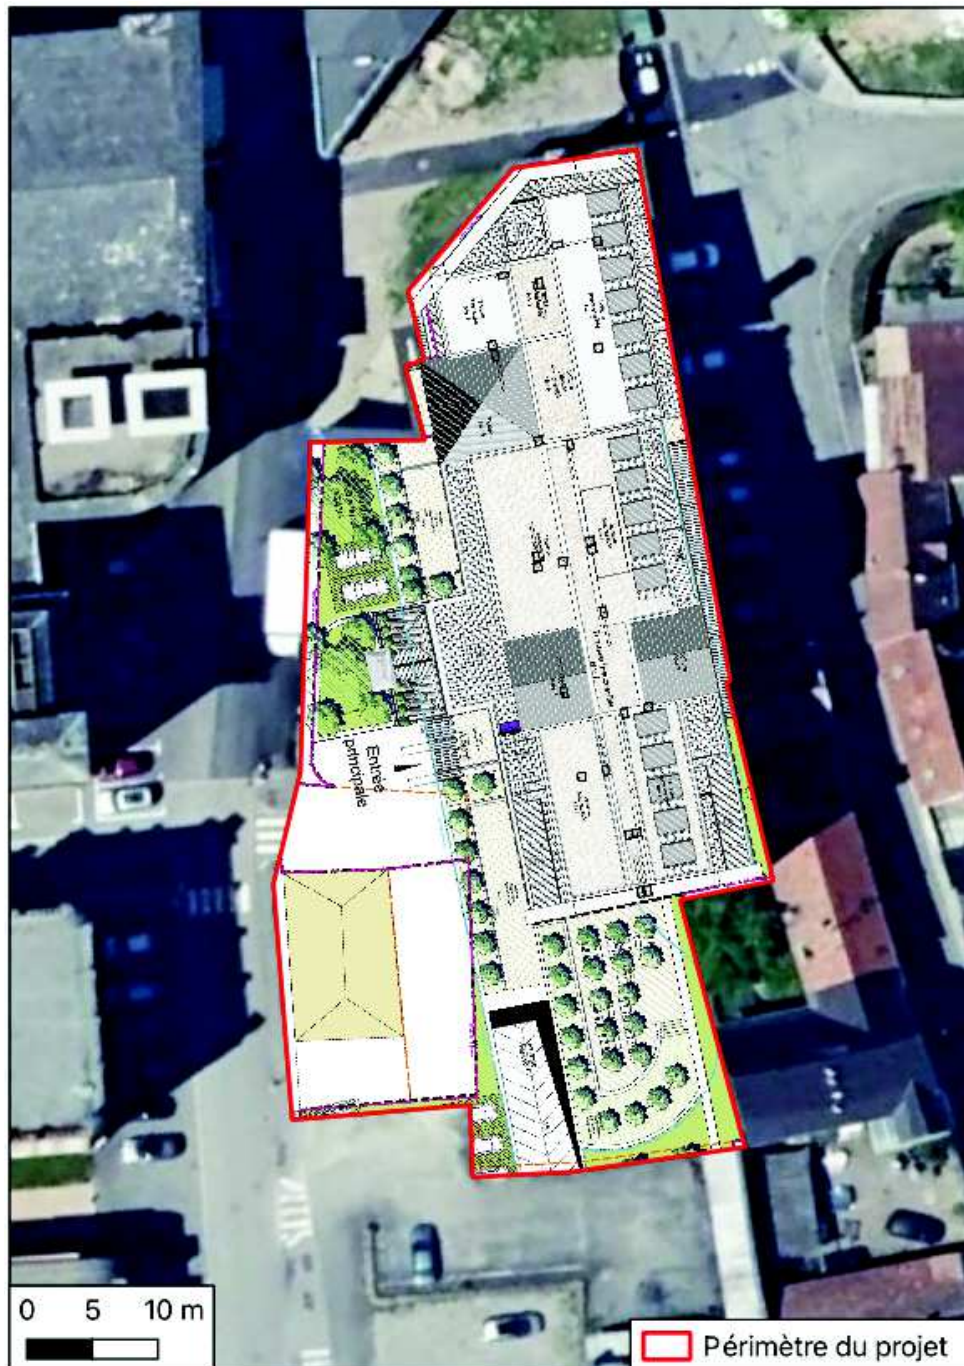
Plan de masse du projet – Source ARCHIMED Environnement et VASCONI ARCHITECTES
